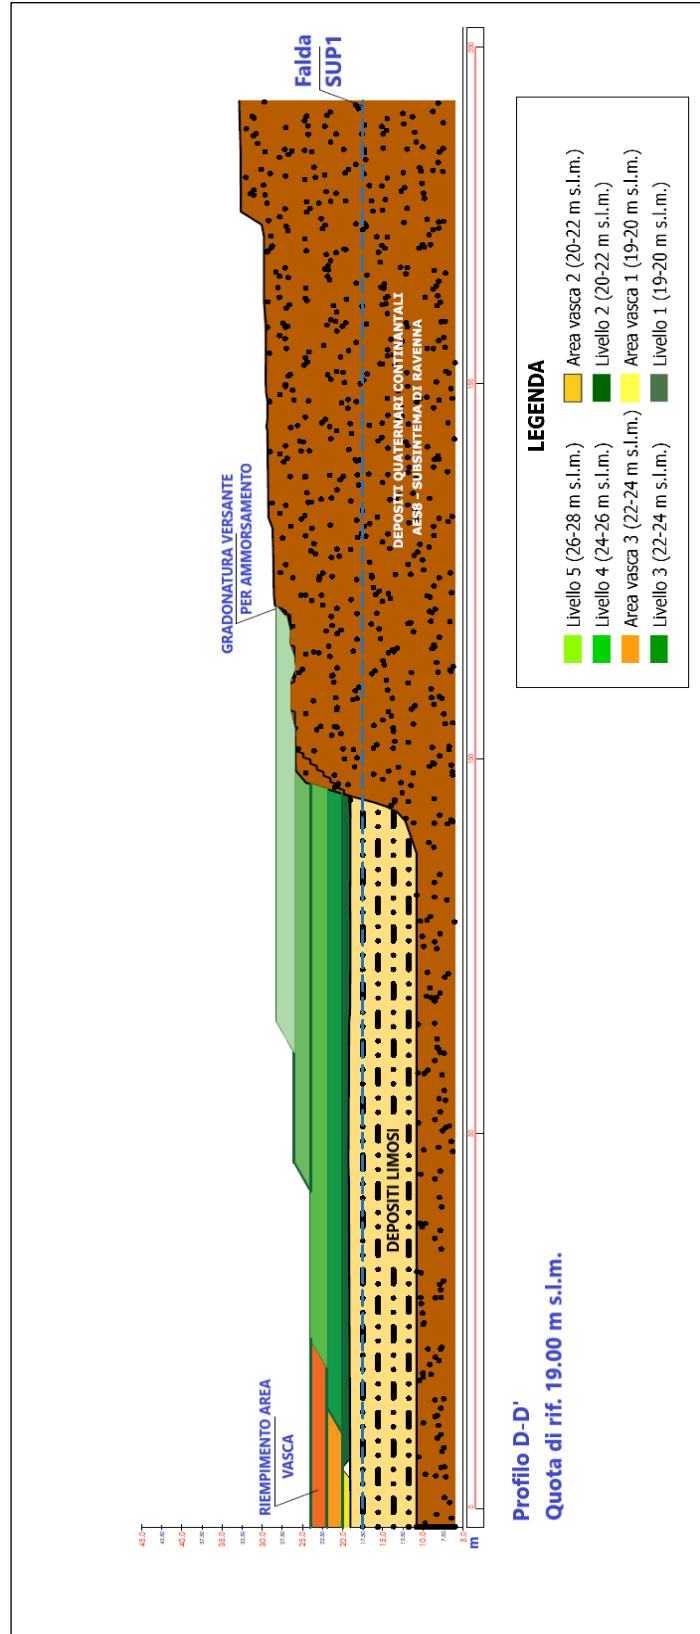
Sezione D- D' sul versante sud di Cava Olmi
